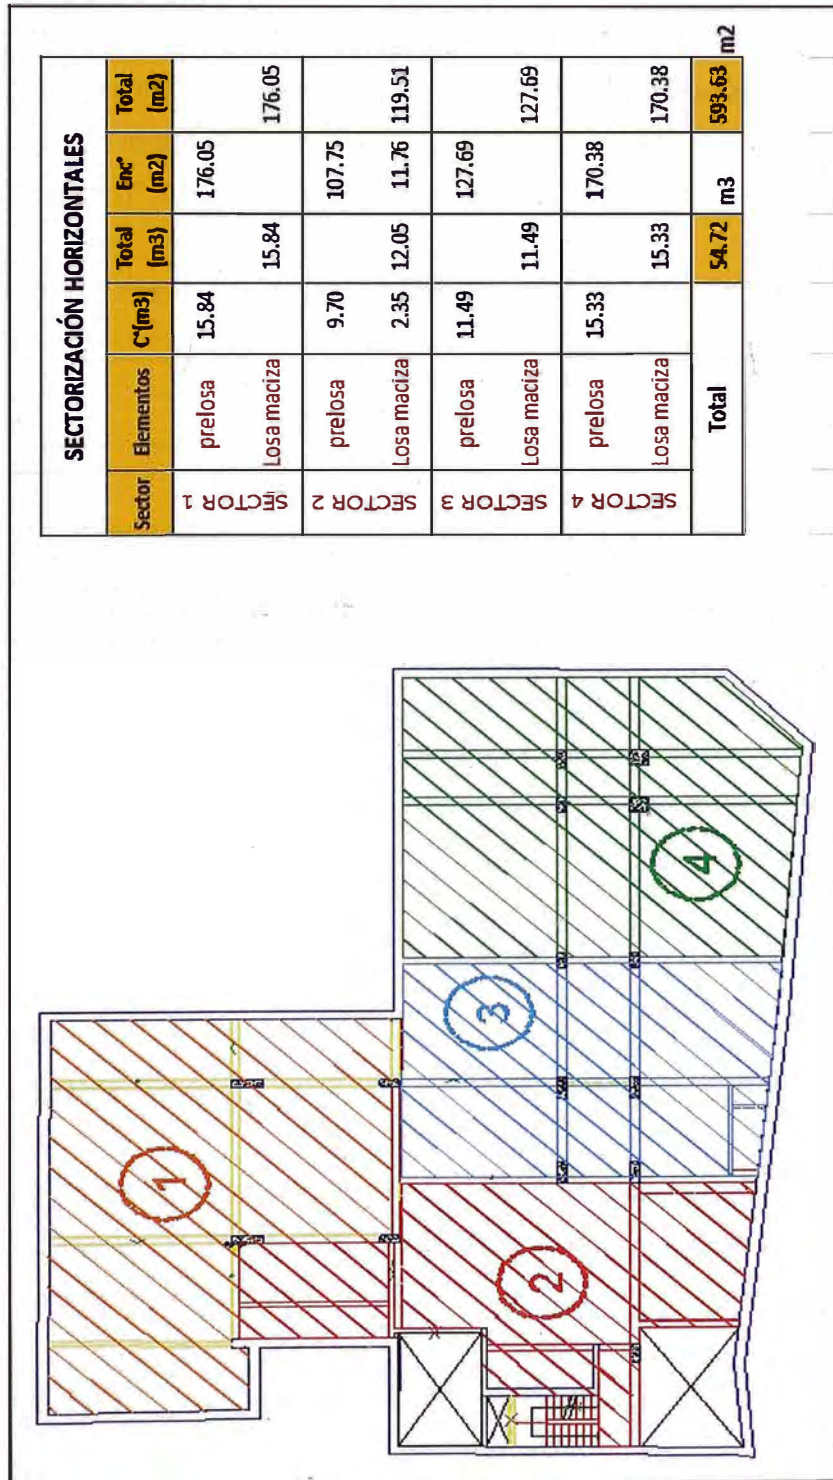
Sectorización de elementos horizontales: Losas.
